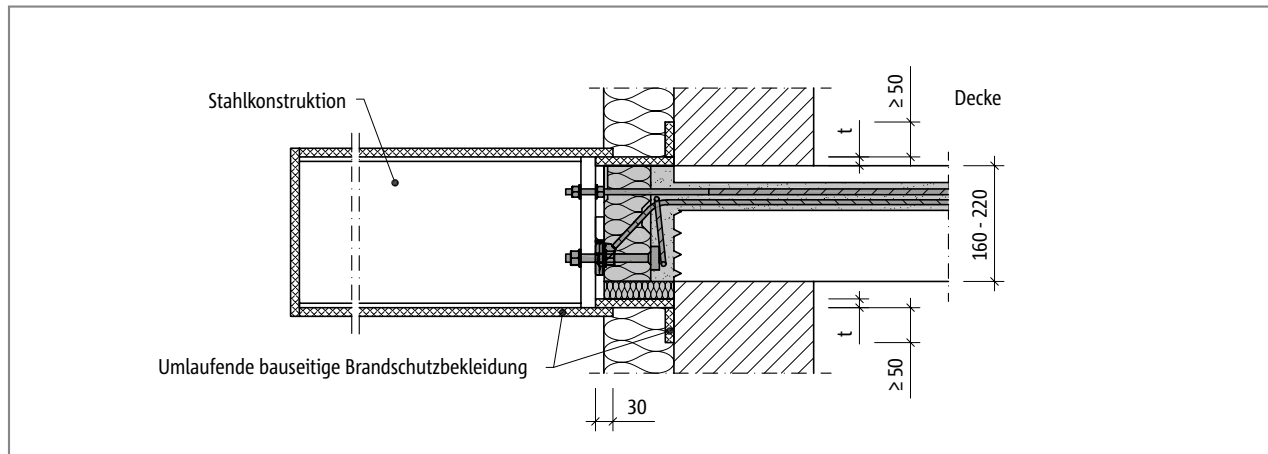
Schöck Isokorb® RT Typ SKP: Bauseitige Brandschutzbekleidung RT Typ SKP und Stahlkonstruktion; Schnitt
